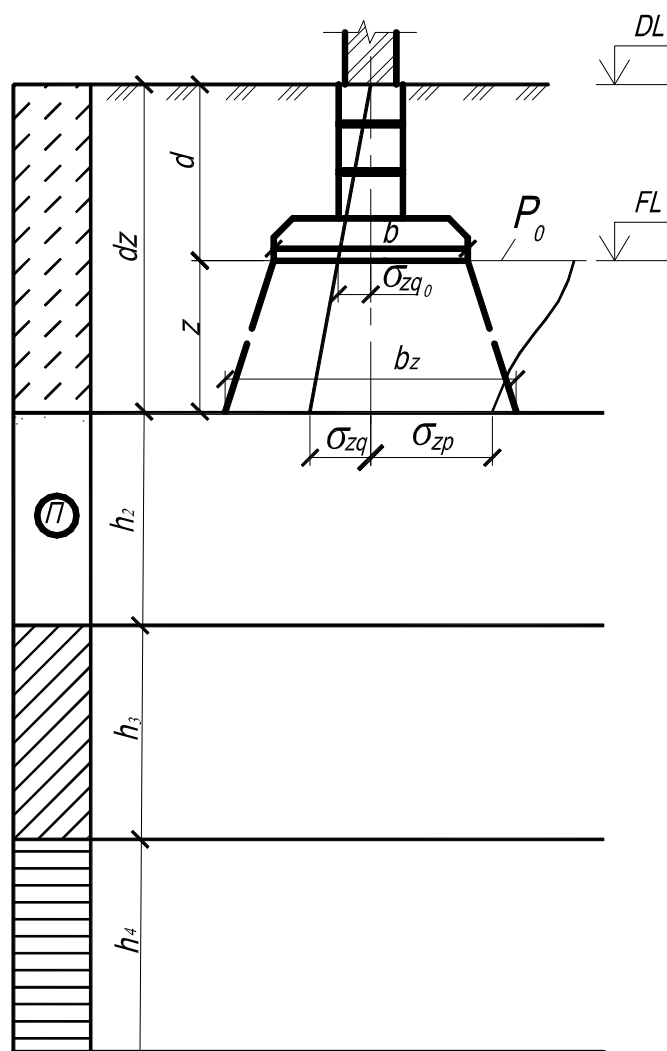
Расчетная схема фундамента при наличии подстилающего слоя слабого грунта
